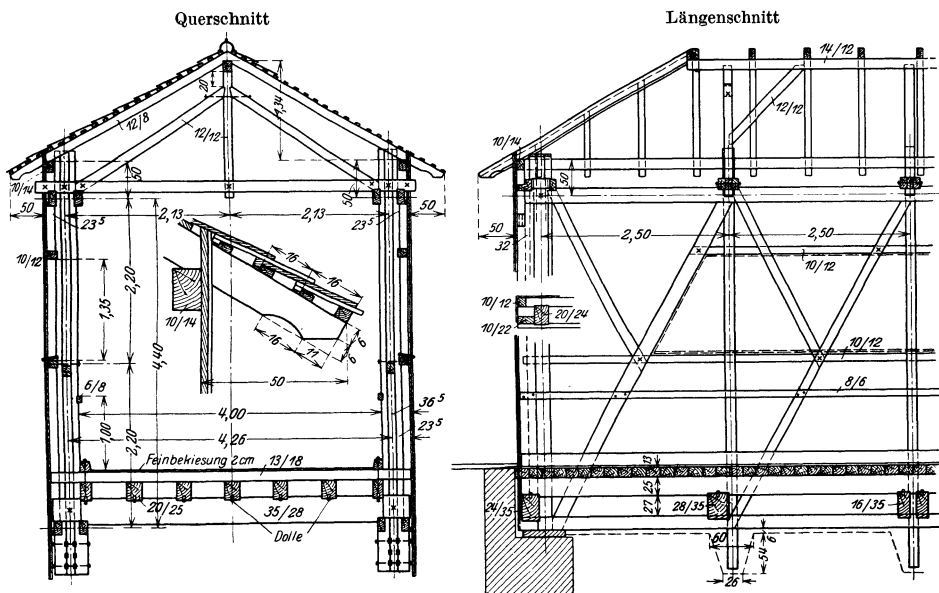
Querschnitt und Teillängenschnitt der Neckarbrücke.
